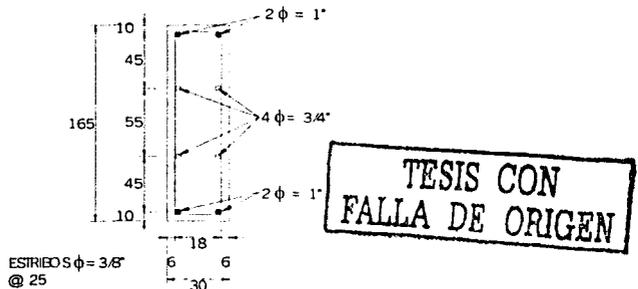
Croquis del Armado de Pantalla Longitudinal
